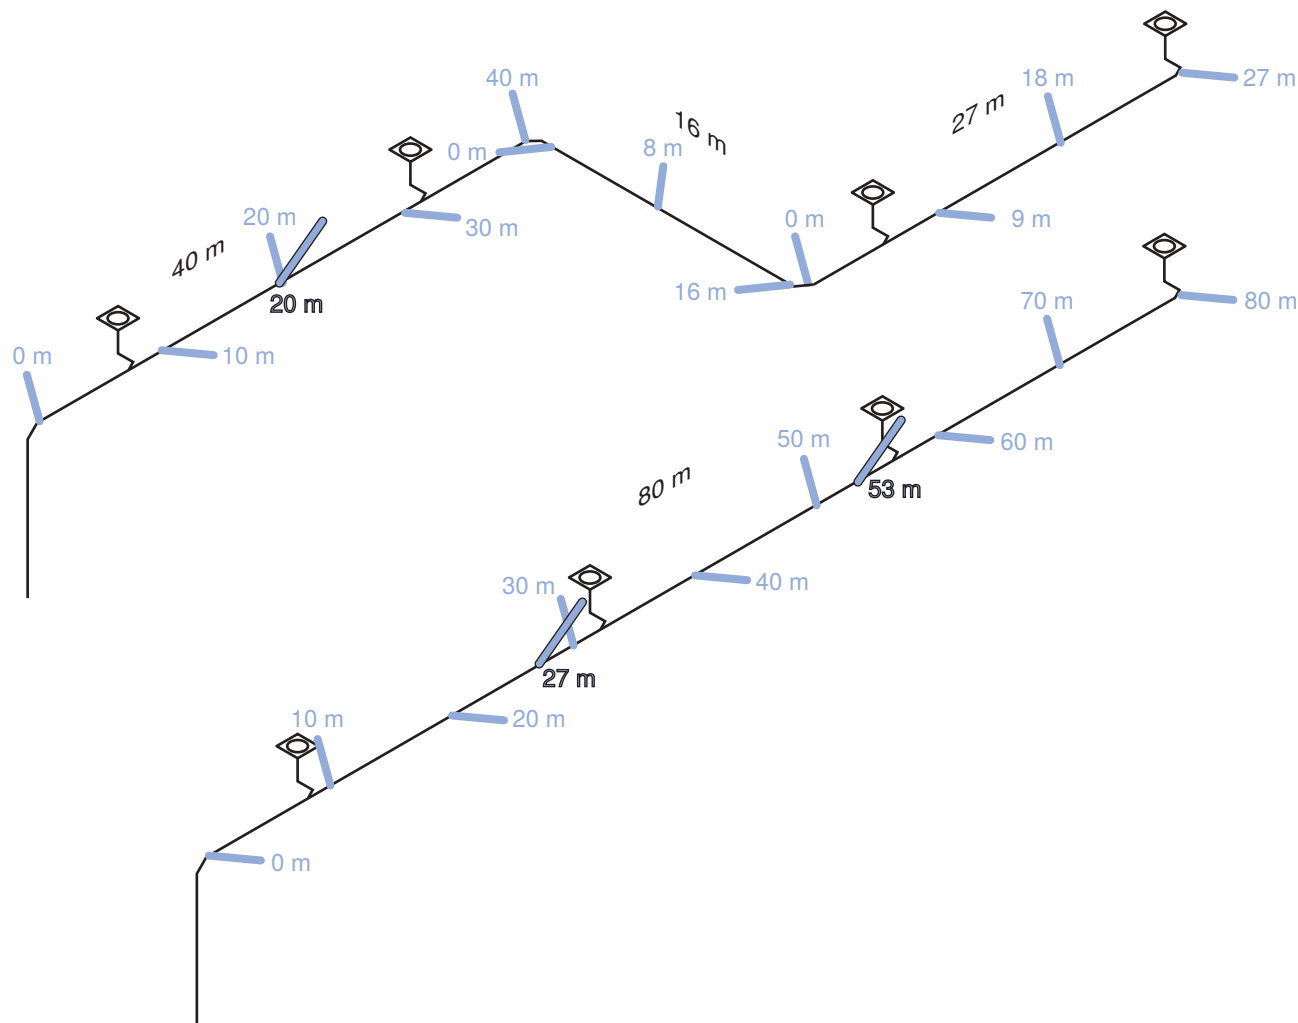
Exemples d'application de supports Geberit Pluvia sur des conduites de raccordement
